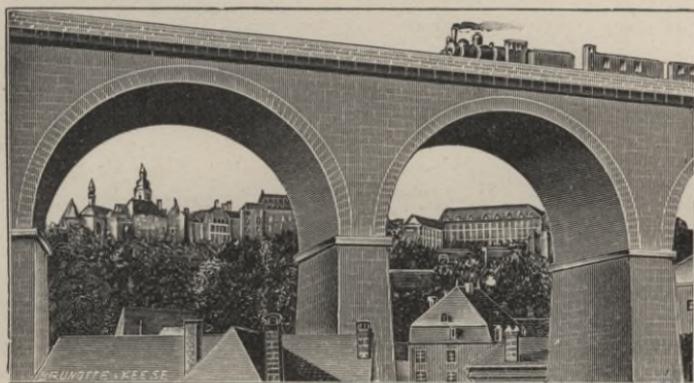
Teil des Grunewald-Viaduktes in Luxemburg.
